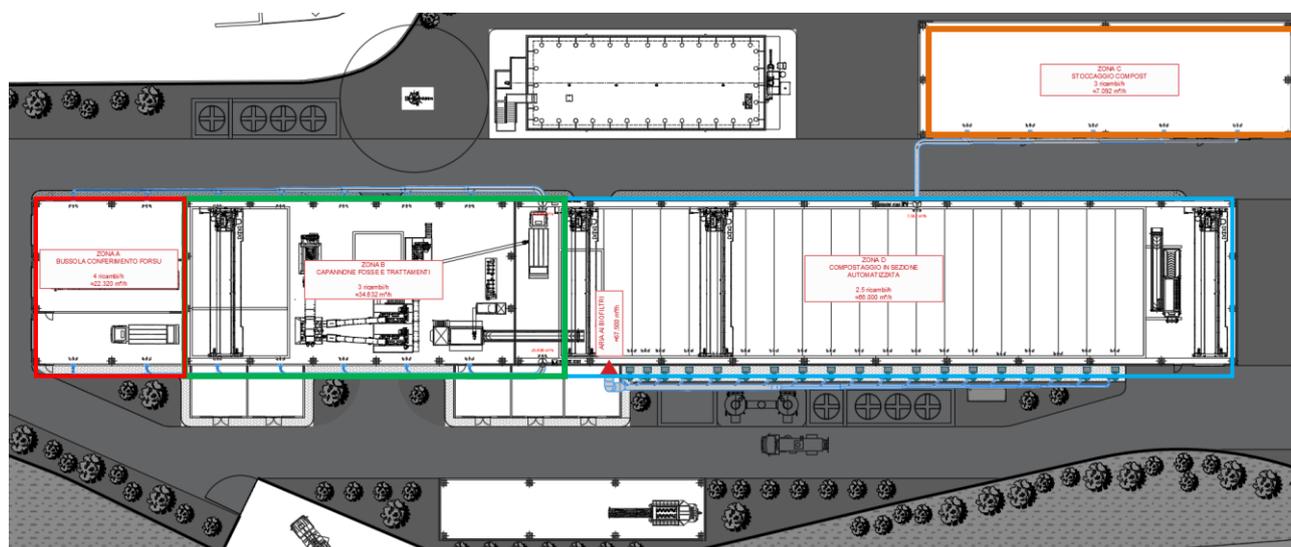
Planimetria trattamento aria estratto tavola T.18 - Planimetria trattamento aria
